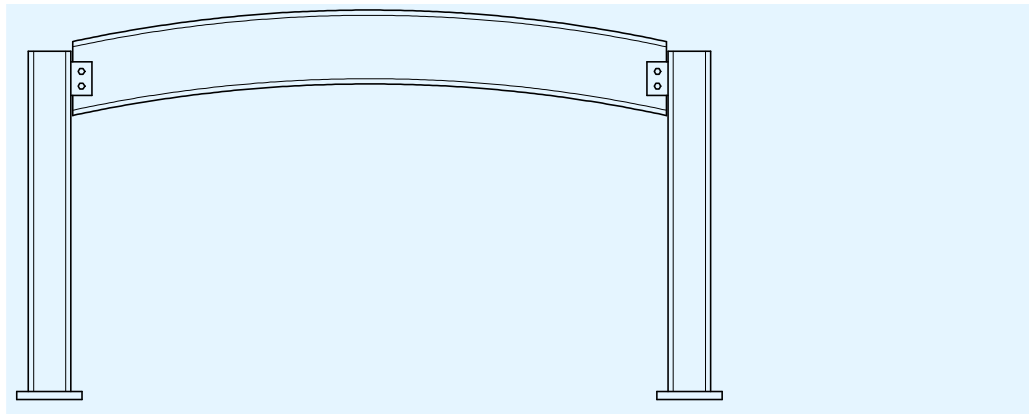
Pórtico simple: viga simplemente apoyada sobre pilares
